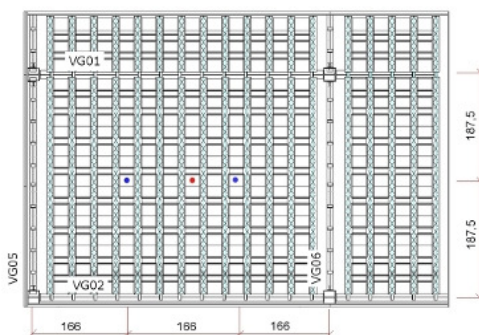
Esquema de carregamento e vista da estrutura - 5ª etapa de carregamento concentrado
